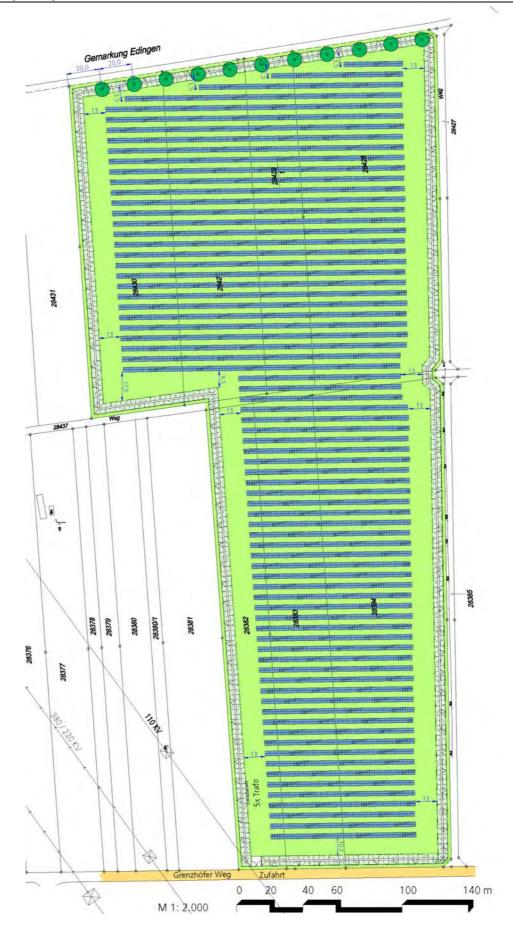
Geplanter Solarpark mit Anordnung der Module und Eingrünung
